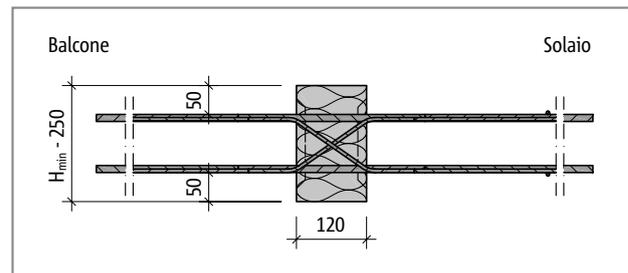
Schöck Isokorb® tipo DXT per CV50: sezione dell'elemento
